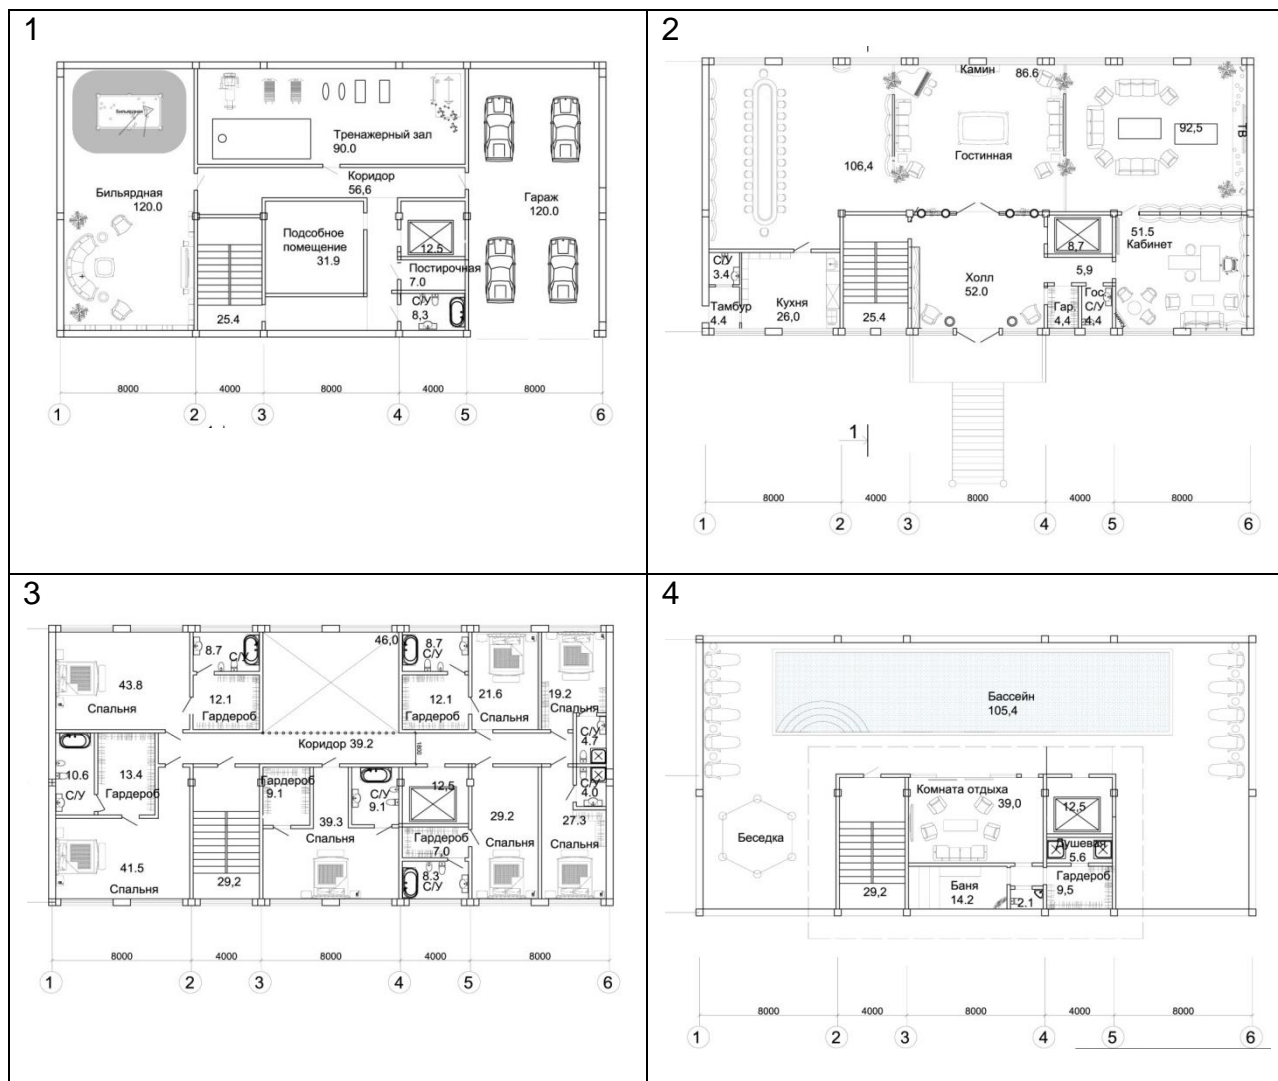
Большой коттедж, г.Алматы, «Европолис» (проект): 1- План подвала; 2 – План первого этажа; 3- План второго этажа; 4 – План эксплуатируемой кровли [материалы компании «Европолис»].
